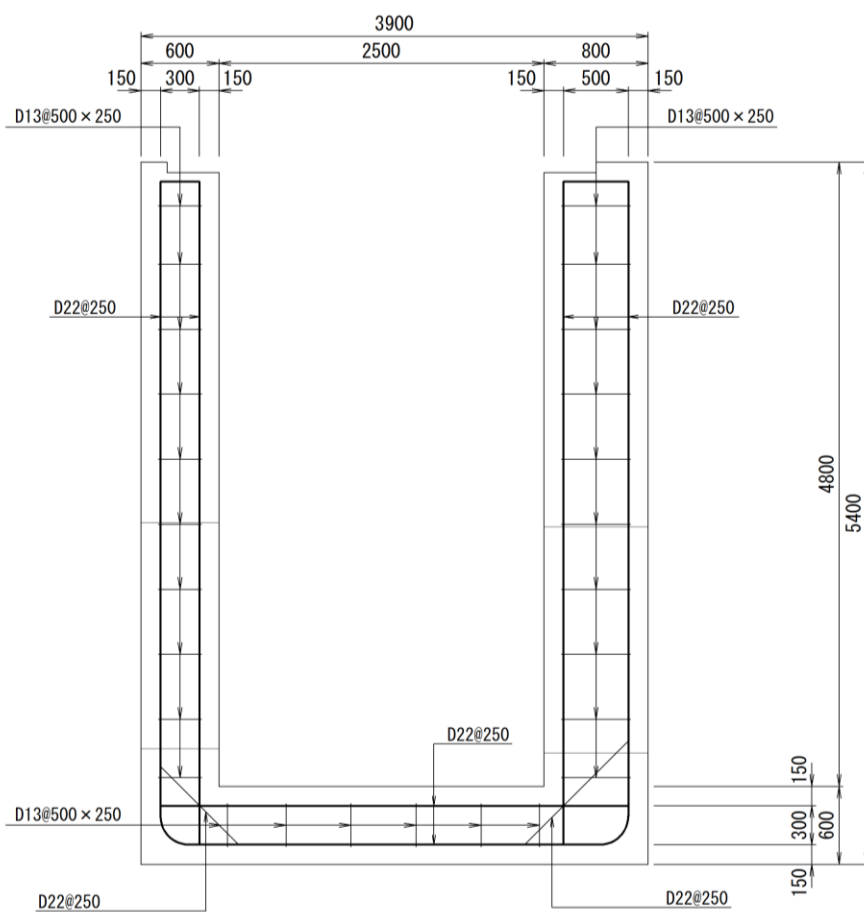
(6) 概略配筋図 (集水枡 (屋外排水路逆止弁⑫))
